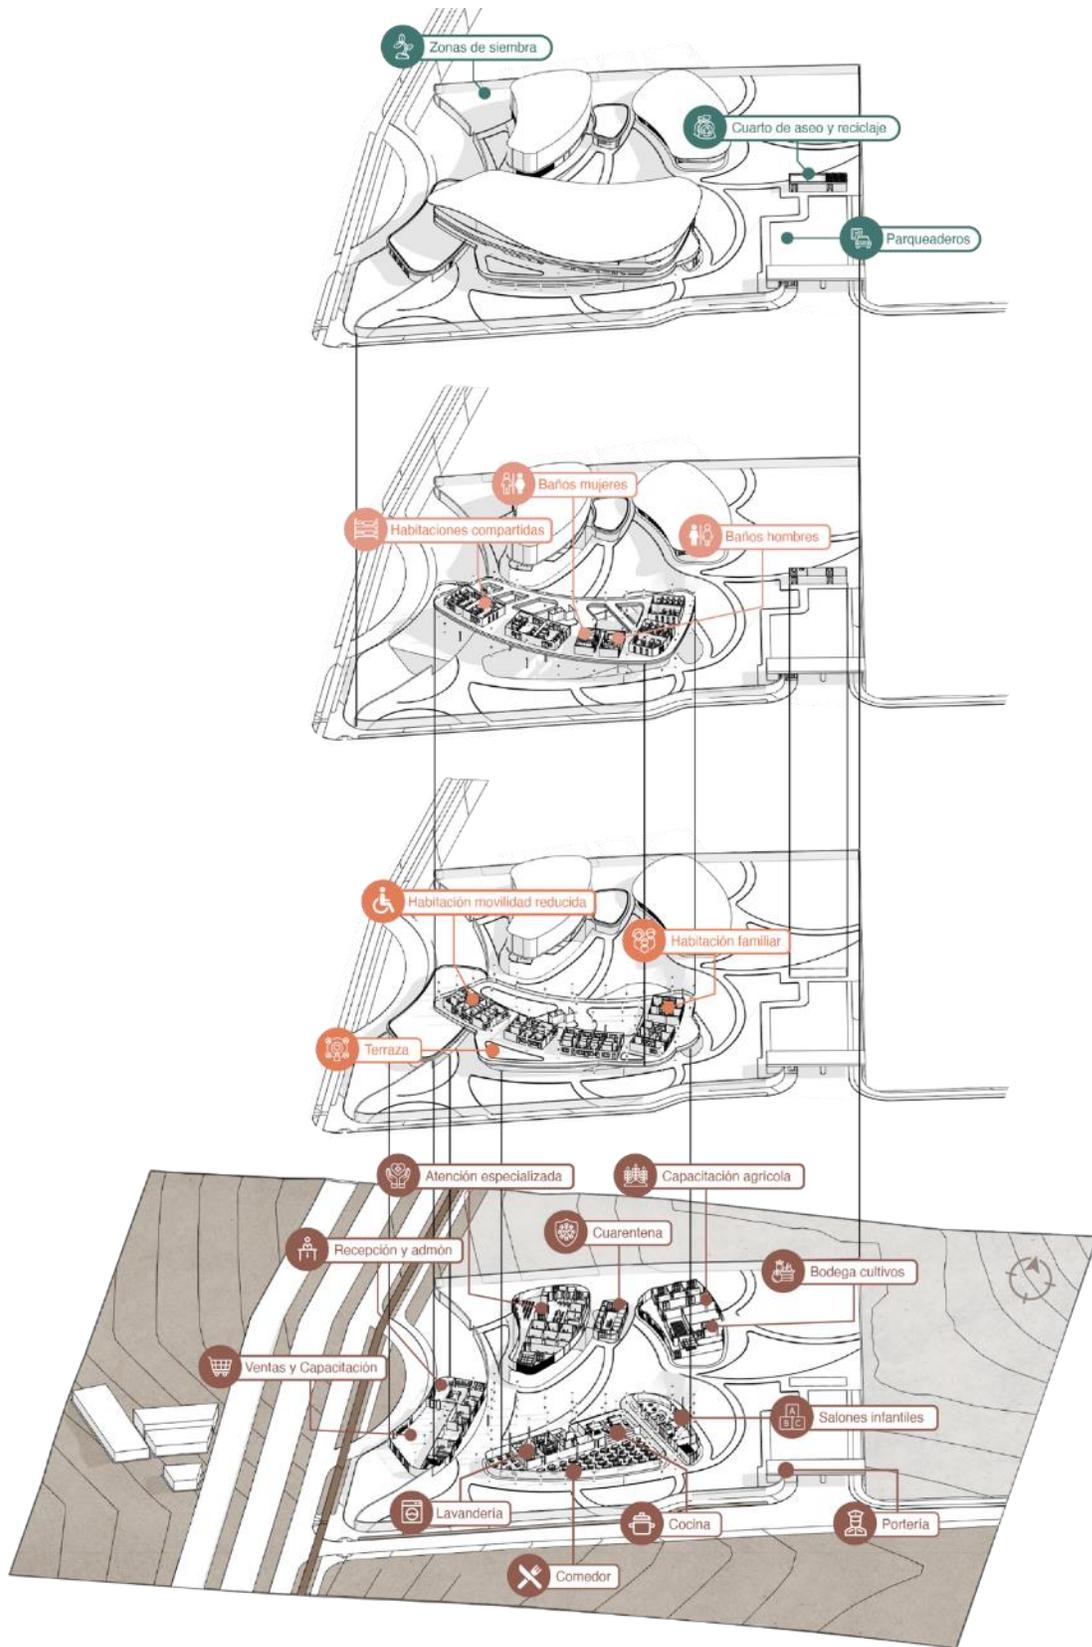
Distribución espacial planta primer piso*EDIFICIO SANTANDER
